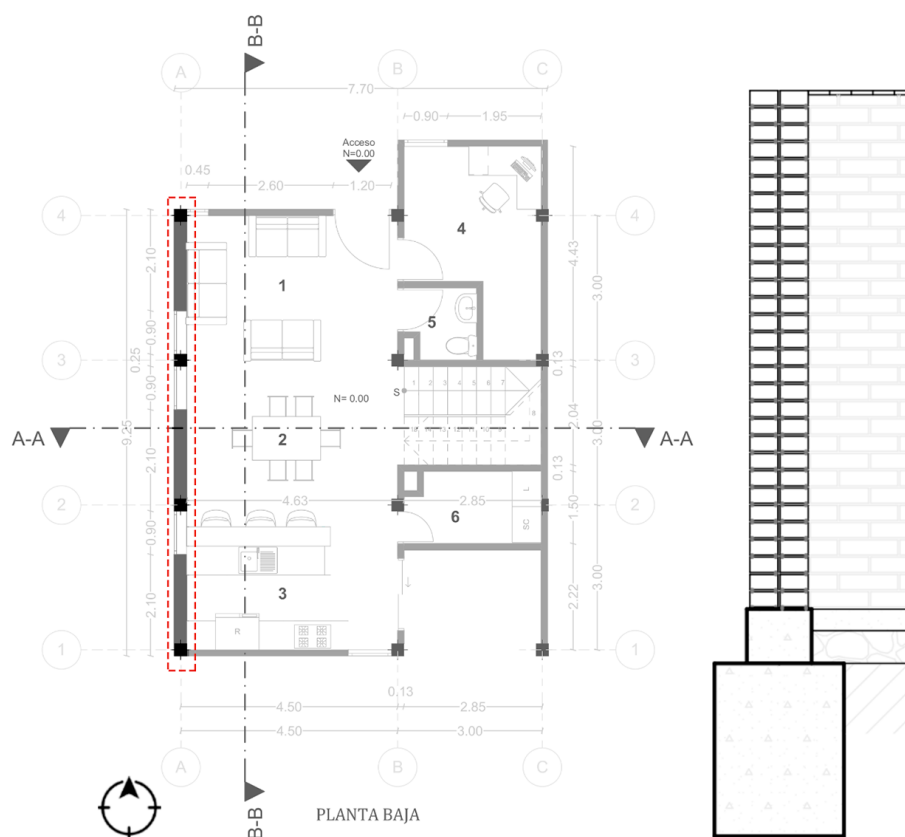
Mampostería de ladrillo doble, ubicada en la fachada oeste de la propuesta de vivienda.
